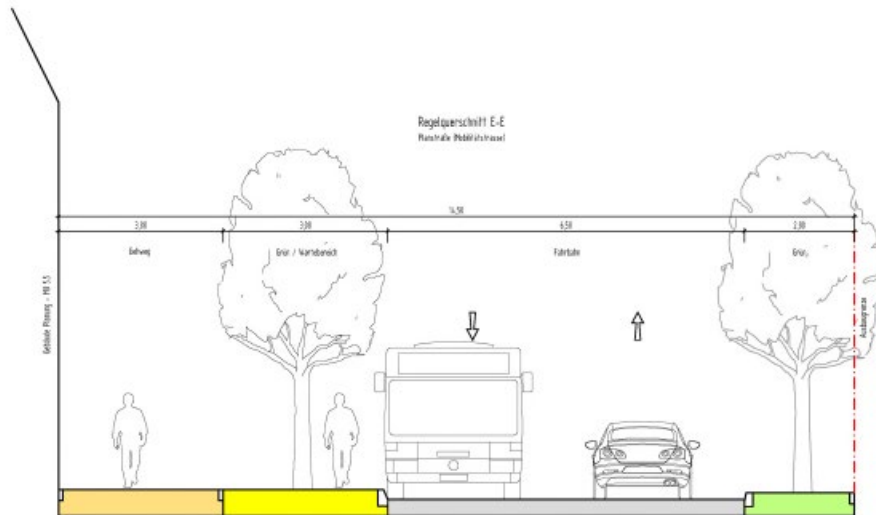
Regelquerschnitt Planstraße 2: links Plangebiet, rechts vorhandene Baumreihe an der östlichen Plangebietsgrenze.
